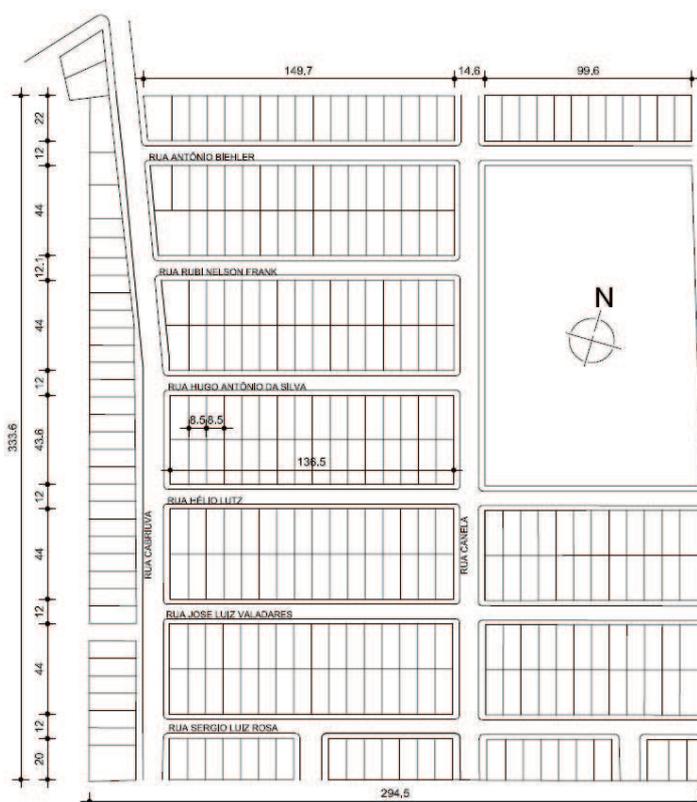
Planta do loteamento Bem-te-vi, Portão, RS. Projeto Prefeitura Municipal de Portão
